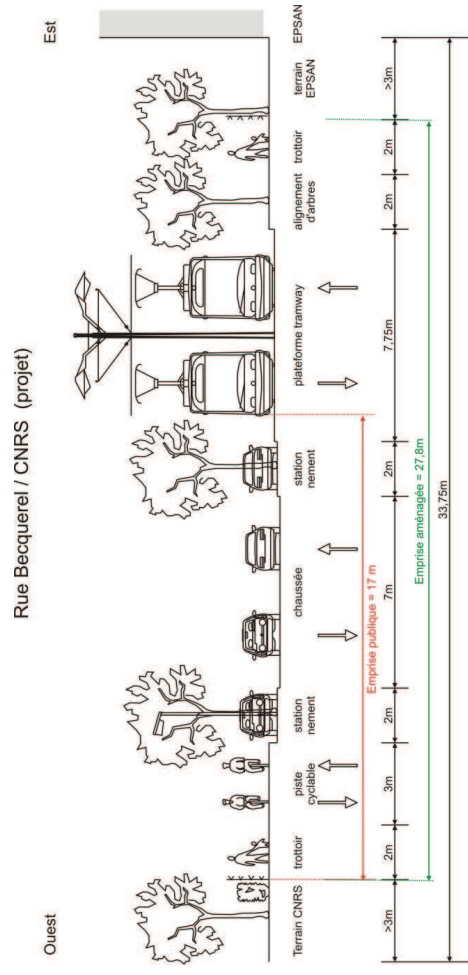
Situation projetée (coupe 14) sur la rue Becquerel
